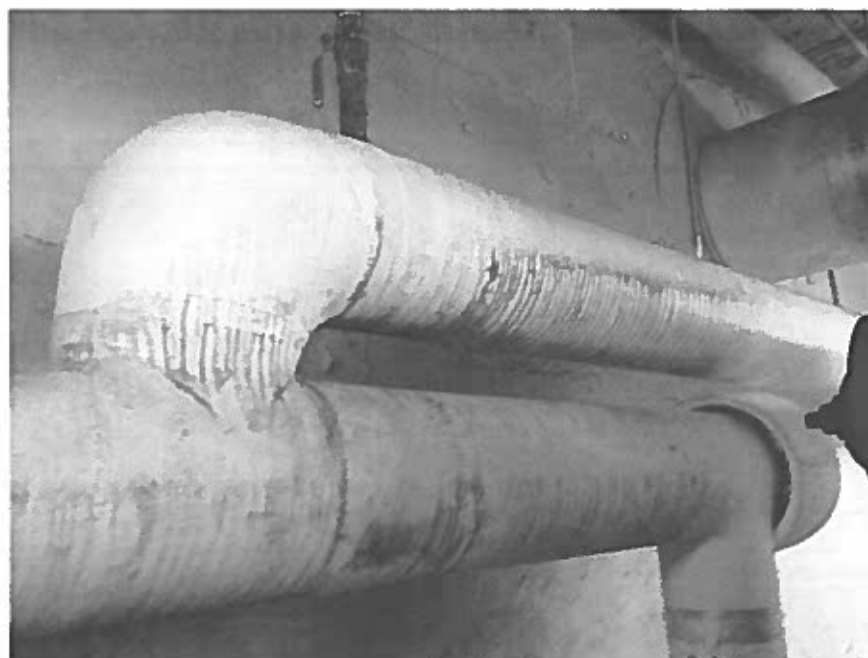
C-001 – Rez-de-chaussée – Isolant avec contamination fongique, VR-2
